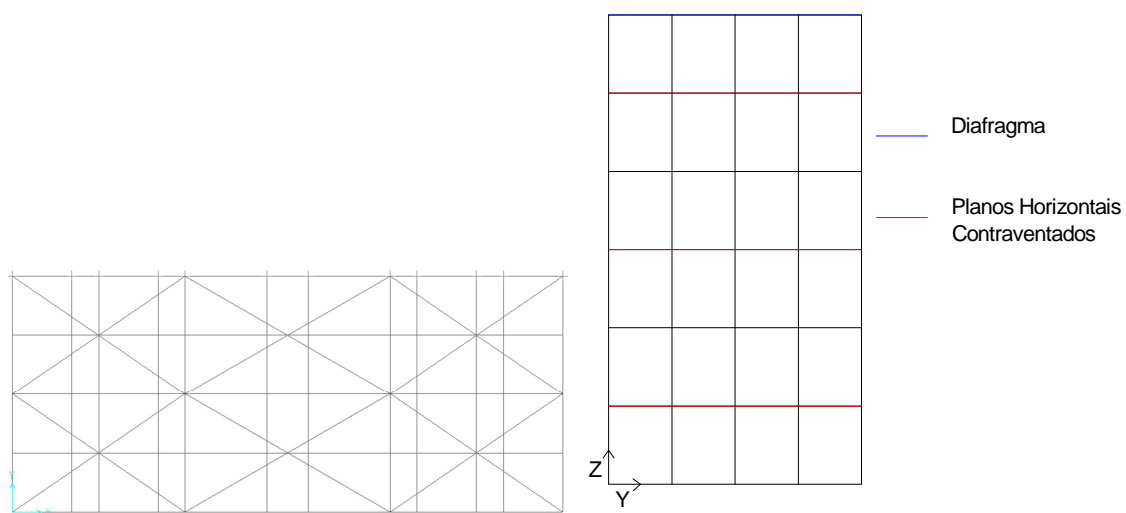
Configuração dos Planos de Contraventamento Horizontal Com Elementos de Contraventamento Grandes
